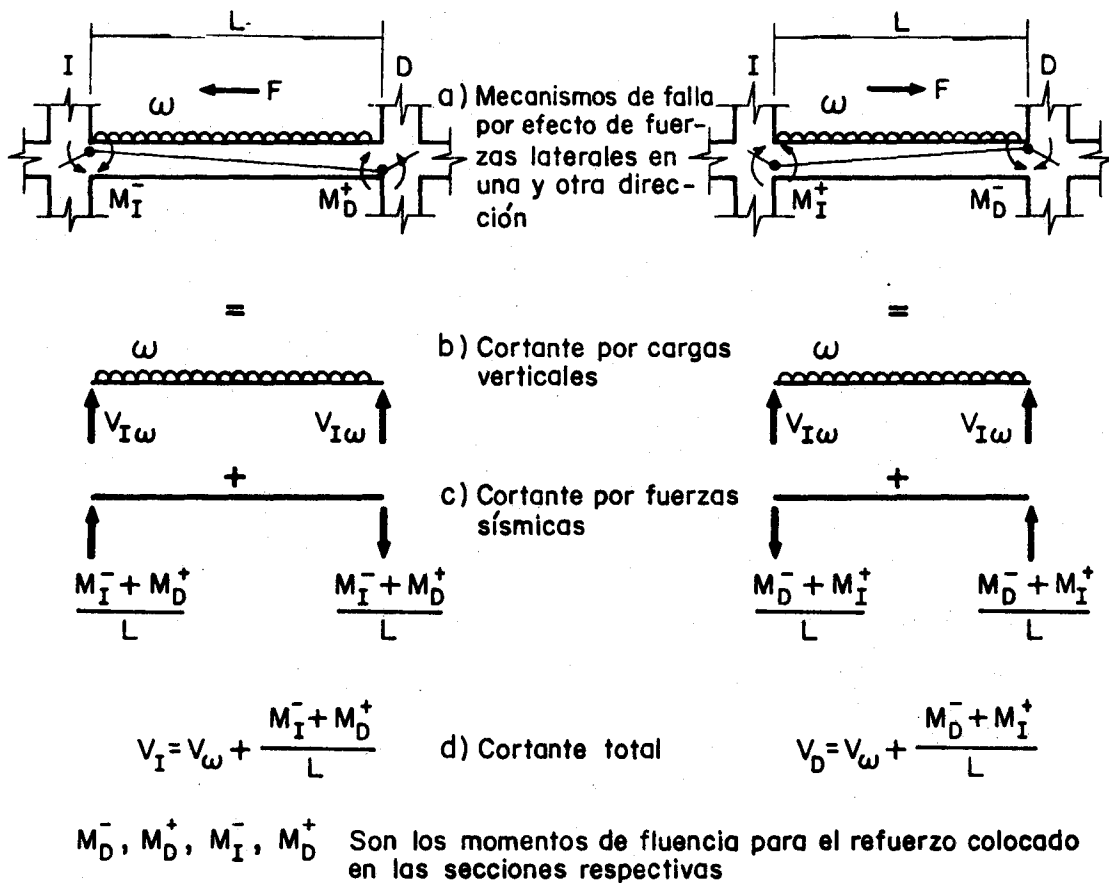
Determinación de las fuerzas cortantes de diseño para vigas de marcos dúctiles de concreto
